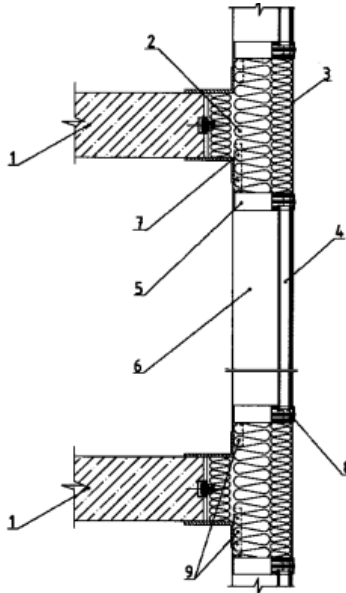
Конструктивна схема збірної системи з суцільним світлопрозорим фасадом із термоізоляцією плит перекриттів: 1 – плита перекриття; 2 – теплоізоляційний шар; 3 – опоряджувальний світлопрозорий шар; 4 – склопакети (із будівельним склом); 5 – елементи несучого каркаса (ригелі); 6 – елементи несучого каркаса (стояки); 7 – кронштейн; 8 – елемент кріплення світлопрозорого опоряджувального шару; 9 – з'єднувальні елементи
